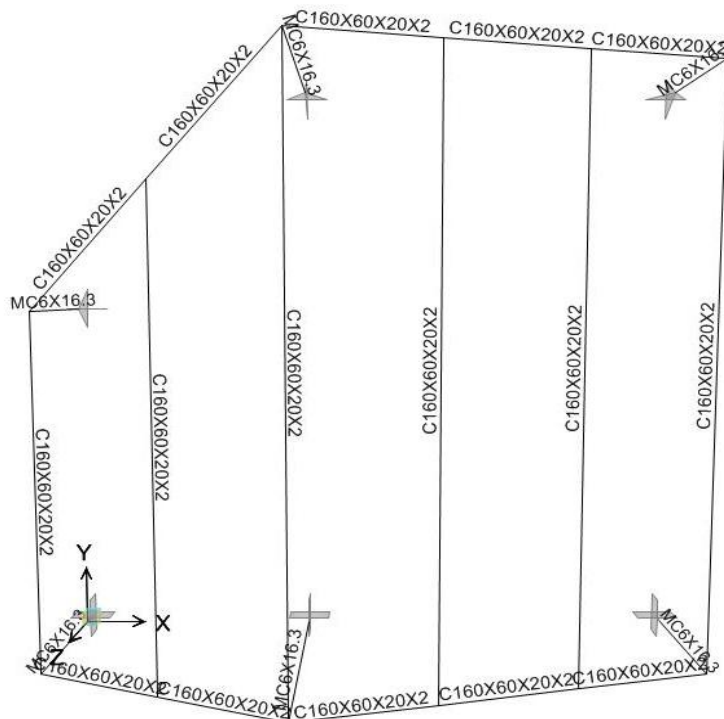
Detalle de la disposición de los perfiles en la cubierta instalaciones antiguo observatorio.
